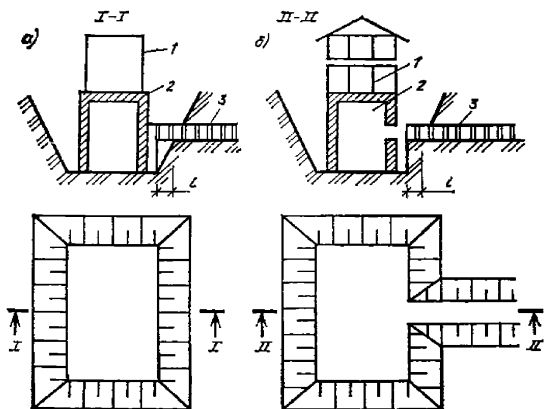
Котлованы под промышленное здание и примыкающий электрокабельный тоннель:
